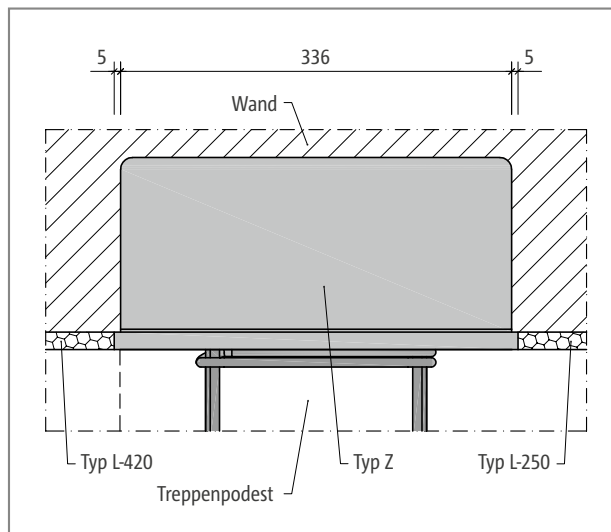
Schöck Tronsole® Typ Z: Elementanordnung, Detail A
